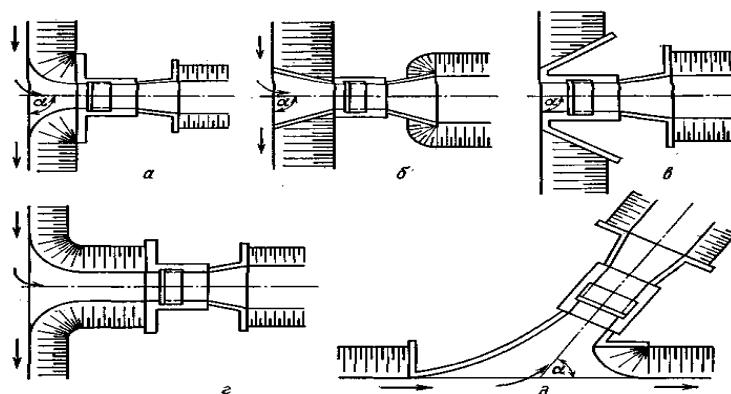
Сопряжение водовыпуска со старшим каналом:
